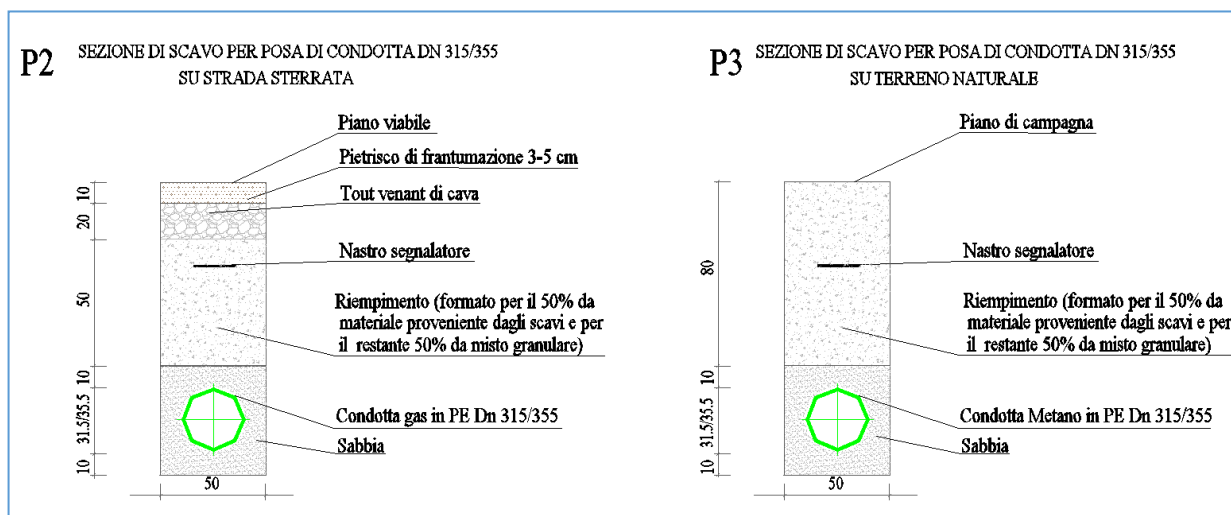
Sezione di scavo per posa condotta su strada sterrata e terreno naturale
